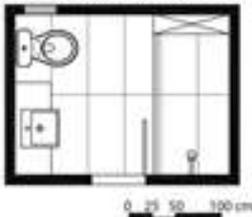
Sugestão "C" de planta baixa do banheiro nº 3.
